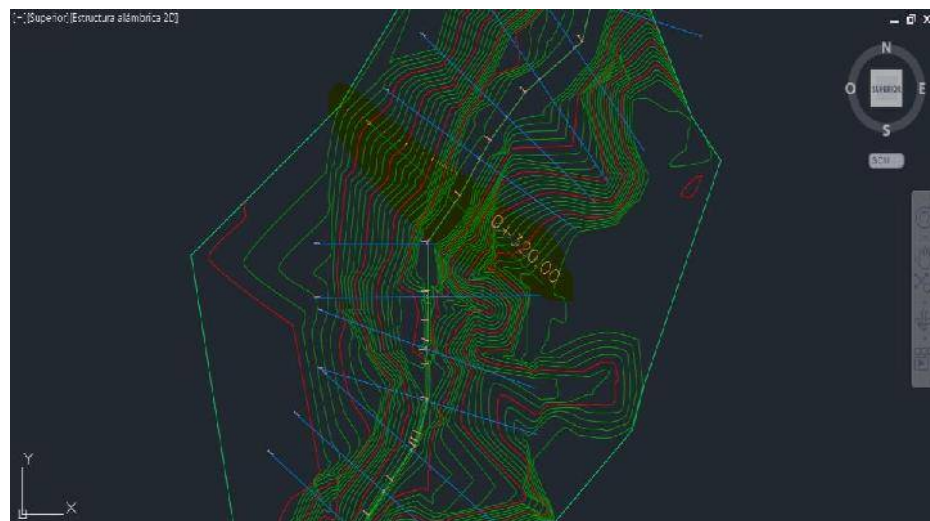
Extracción de primera muestra crítica, Tramo 1: 0+100 km
